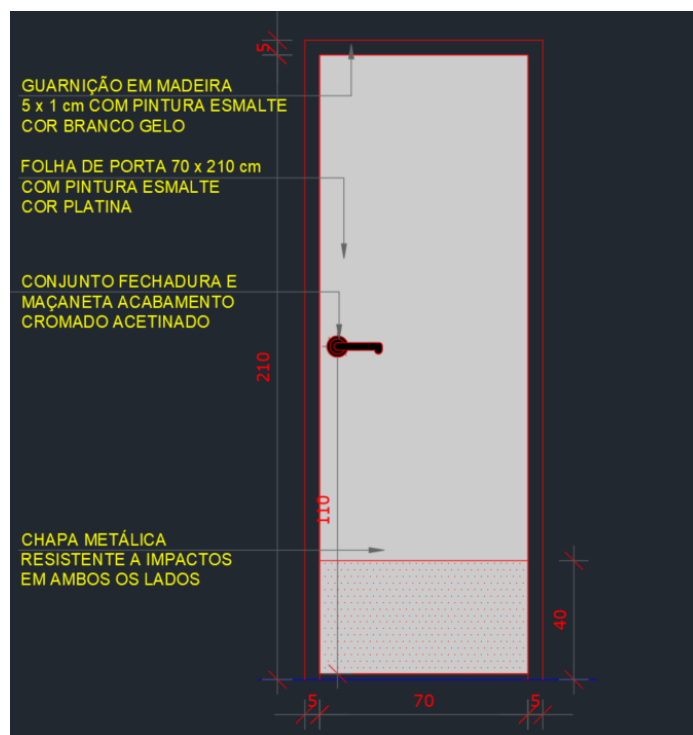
Corte projeto PM1 conforme deve ser executado.
